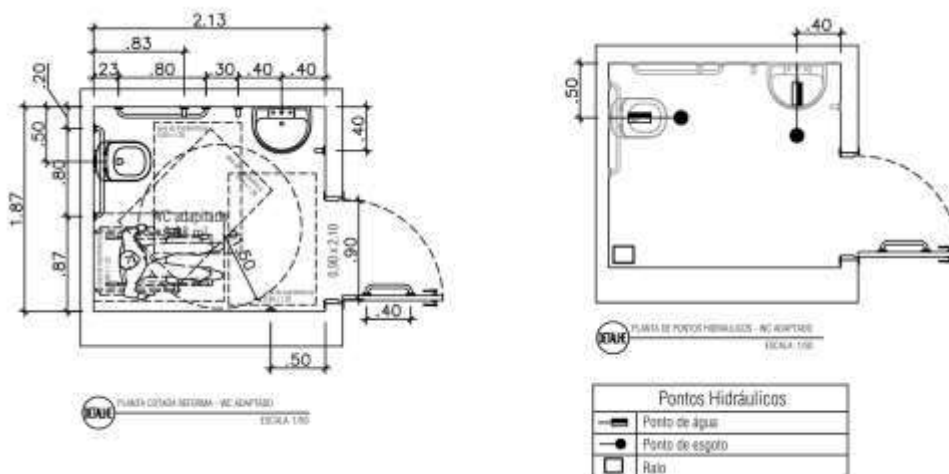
Planta de pontos hidráulicos banheiro PNE (sem escala)
